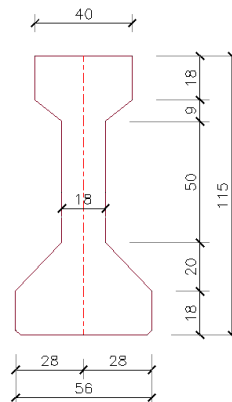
Sección transversal de la viga AASTHO tipo III (unidades en cm).
